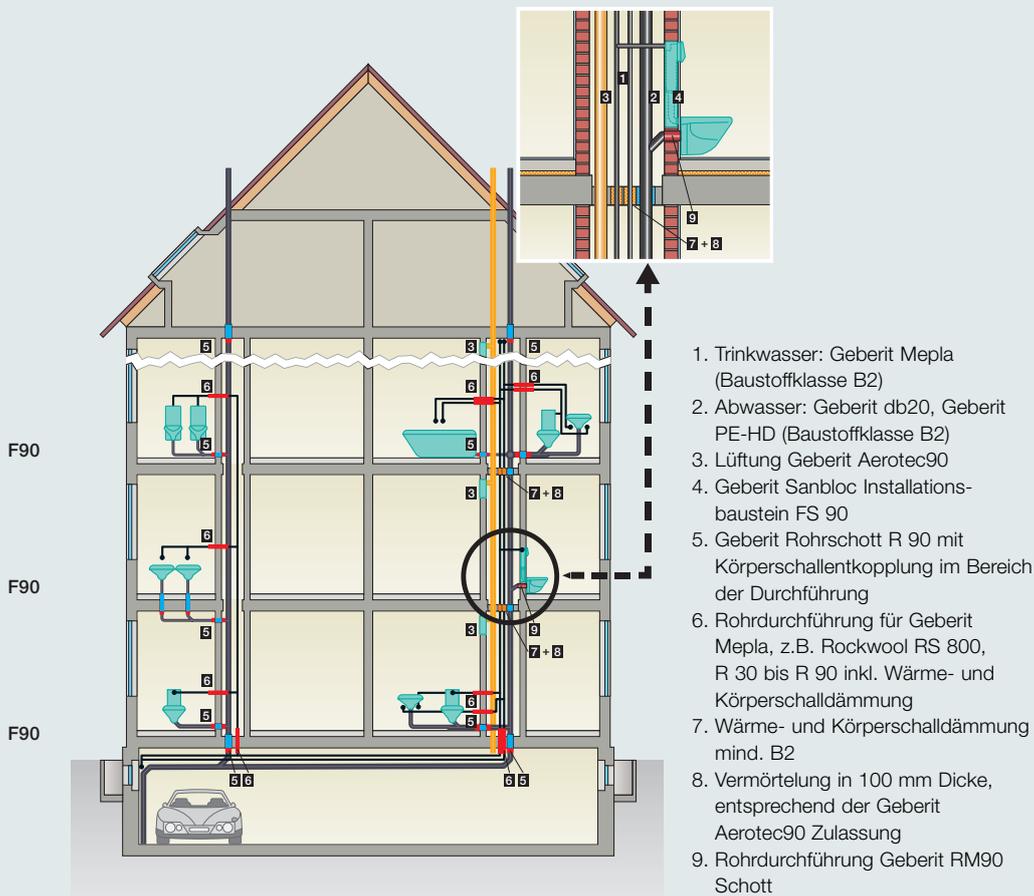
Klassifizierter Installationsschacht nach DIN 4102-4 mit dem Sanbloc Installationsbaustein FS 90 (Abbildung rechter Schacht)
